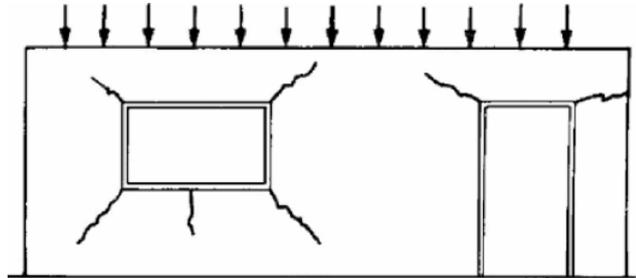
fissuras nos cantos das esquadrias indicando ausência ou má execução de vergas e contravergas.
